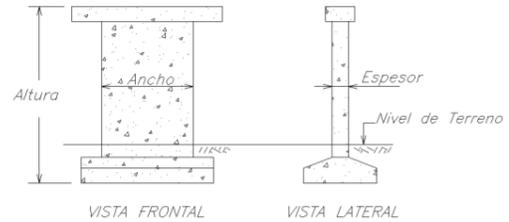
Pila tipo muro. Fuente: MOPT (2007).
